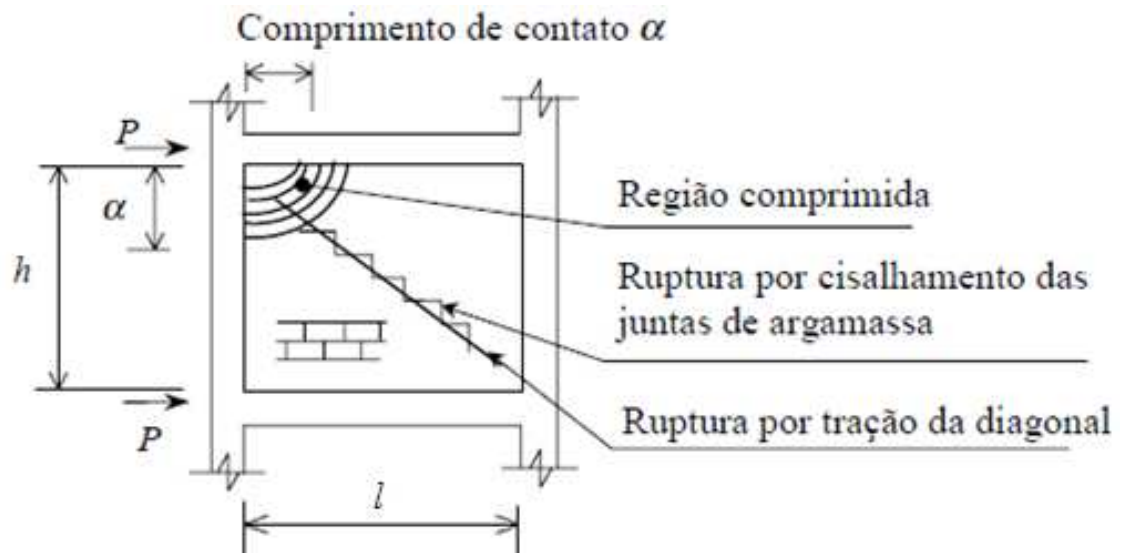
Modos de ruptura da alvenaria em sistemas de pórticos preenchidos.
